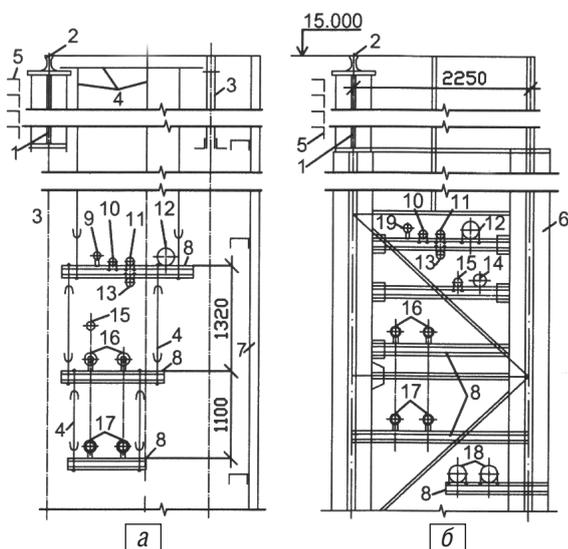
Прокладка коммуникаций: на подвесках к балкам, укладываемым сверху на подкрановые конструкции (а); в колоннах здания цеха (б): 1 – подкрановая балка; 2 – подкрановый рельс; 3 – вспомогательная ферма подкрановой металлоконструкции; 4 – балка и шарнирные тяги для крепления подвесок; 5 – троллей крана; 6 – колонны; 7 – стена цеха; 8 – подопорные конструкции; трубопроводы: 9 – кислорода \varnothing 50, 1,6 МПа (на ремонтные нужды); 10 – сжатого воздуха \varnothing 50, 0,7 МПа (на ремонтные нужды); 11 – газопровод \varnothing 50 среднего давления – 0,15 МПа; 12 – \varnothing 200 высокого давления – 0,6 МПа (то же); 13 – азота \varnothing 40, 2,0 МПа; 14 – противопожарный \varnothing 150, 0,6 МПа; 15 – питьевой воды \varnothing 100, 0,4 МПа; 16 – теплоснабжения (прямой и обратный) $2 \times \varnothing$ 70, 130/70 °С, 0,8/0,4 МПа; 17 – то же, $2 \times \varnothing$ 100; 18 – водовод $2 \times \varnothing$ 200; 19 – кислород \varnothing 50, 1,6 МПа – технологический
